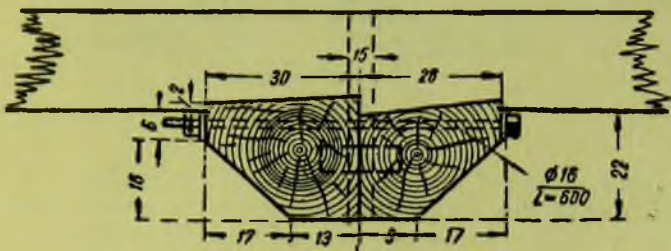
Типы деревянных узловых подушек ферм Гау.
